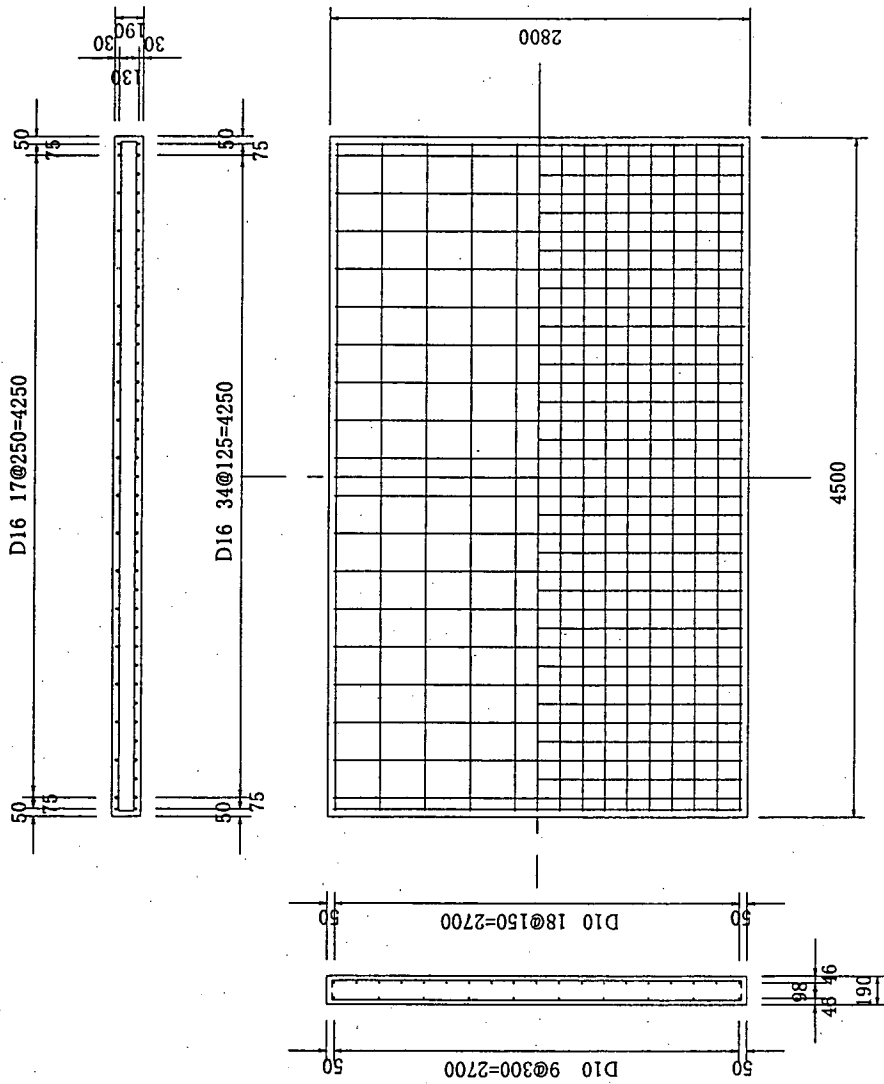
RC39-2供試体の形状・寸法 (単位:mm)
